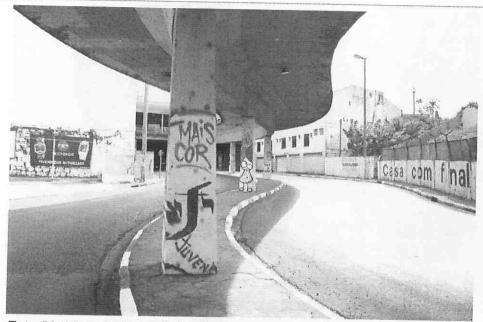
Vista da face inferior da estrutura (pilar+viga de travamento+laje) da passarela apresentando armadura exposta na viga de travamento e na laje, eflorescência na laje e na viga, infiltração vinda da rachadura na face superior do tabuleiro e mofo nos pilares.
